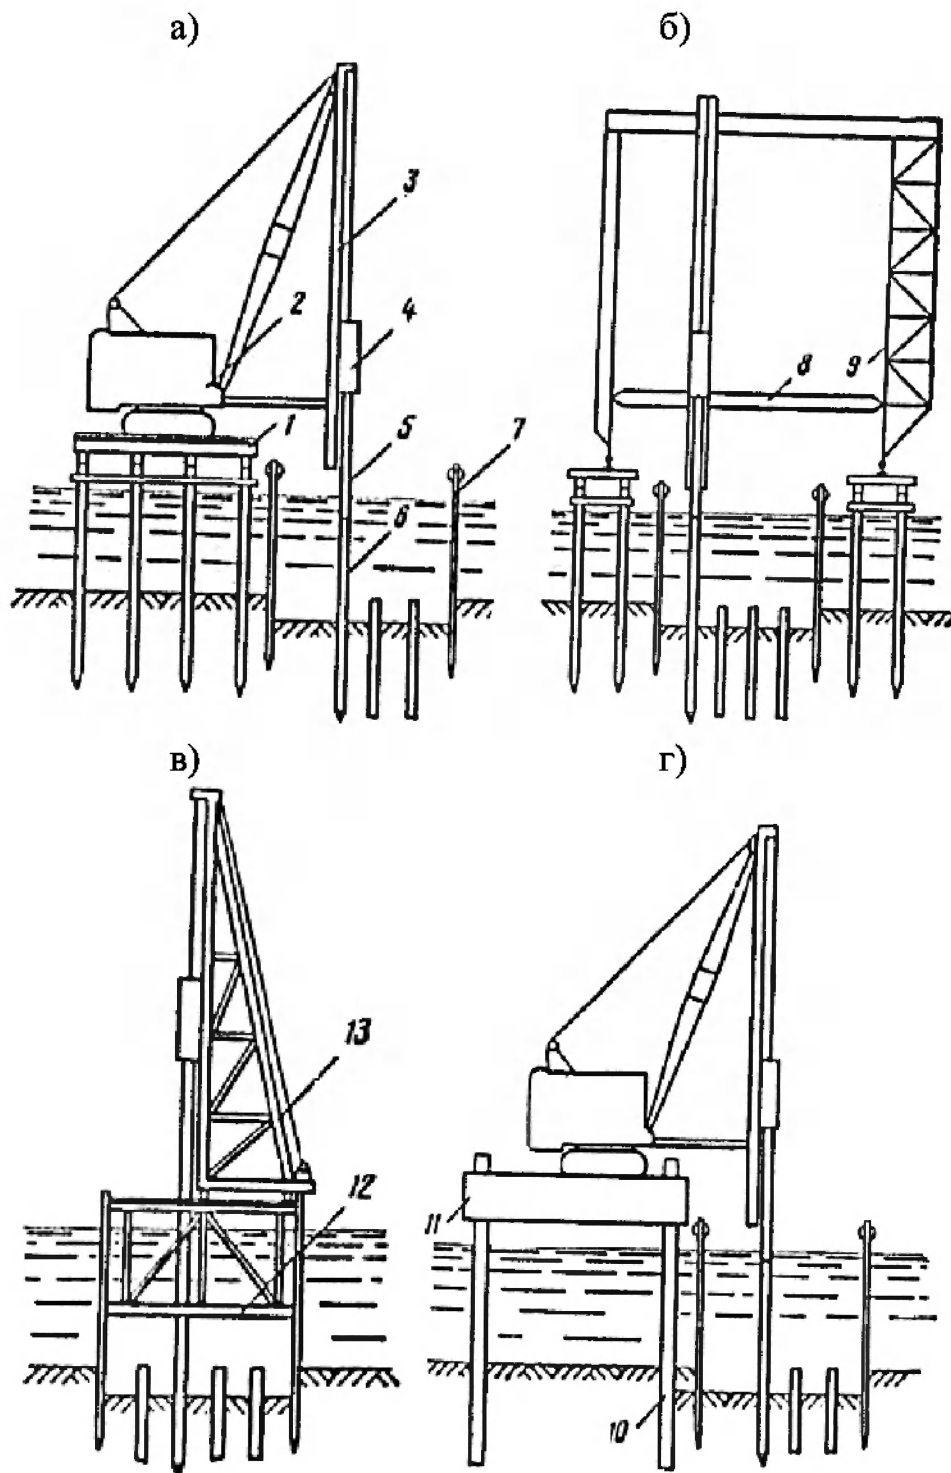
Использование временных подмостей для производства работ по сооружению фундаментов:
